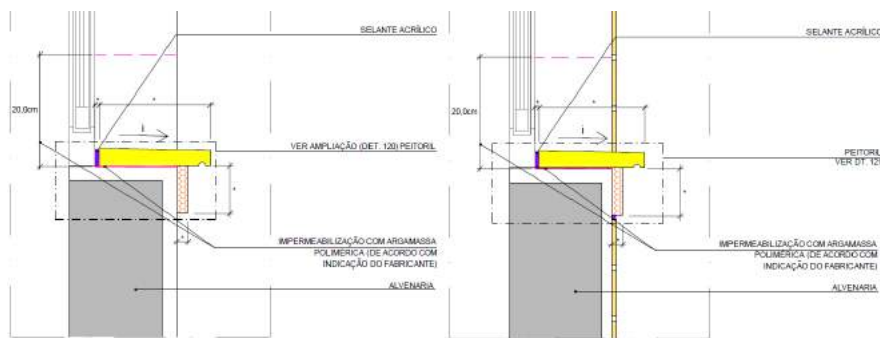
Elemento de EPS na fachada - Projeto de Produção de fachada (R1)
